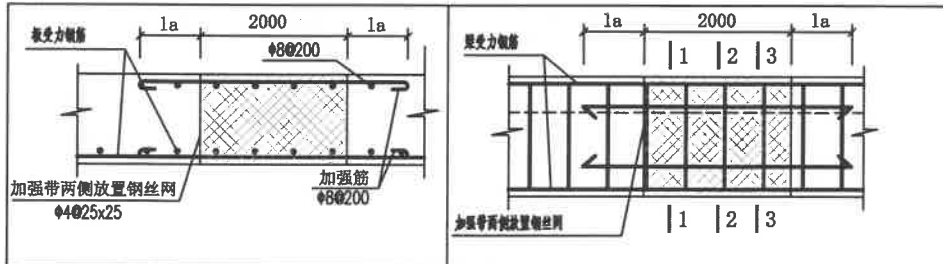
2 加强带板施工构造 图10a-3 加强带梁的施工构造
